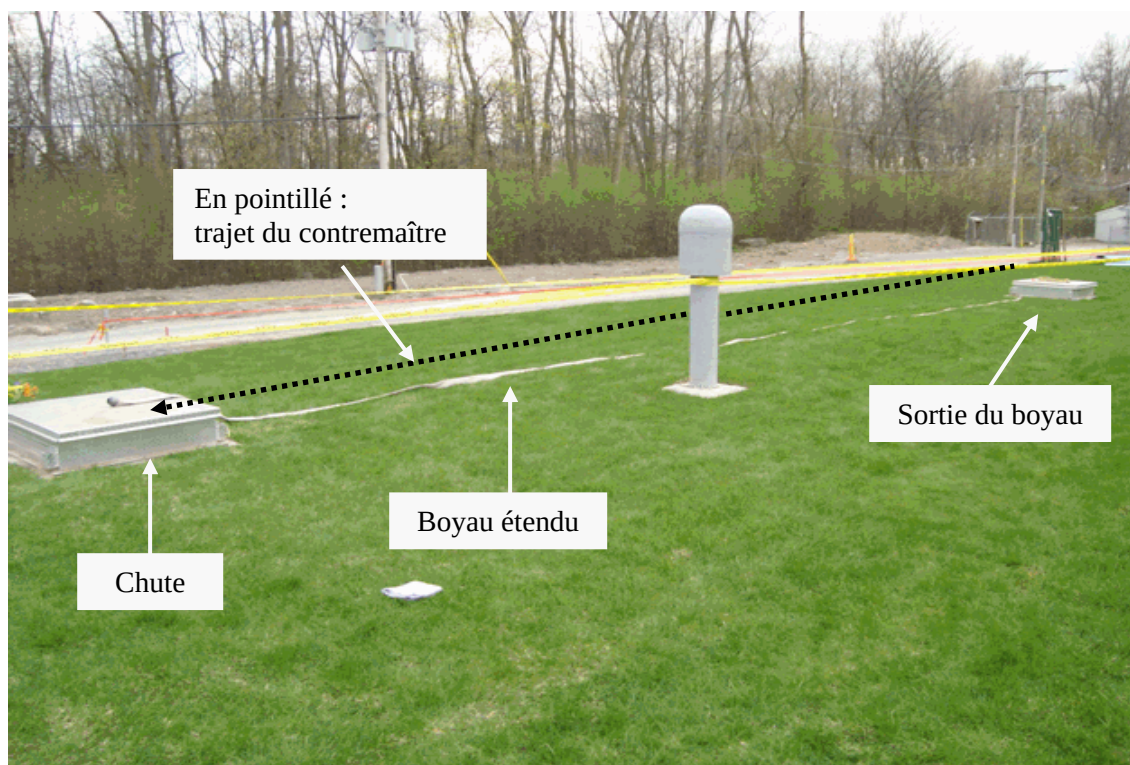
Puits d'accès 2 et 3 du réservoir 5
